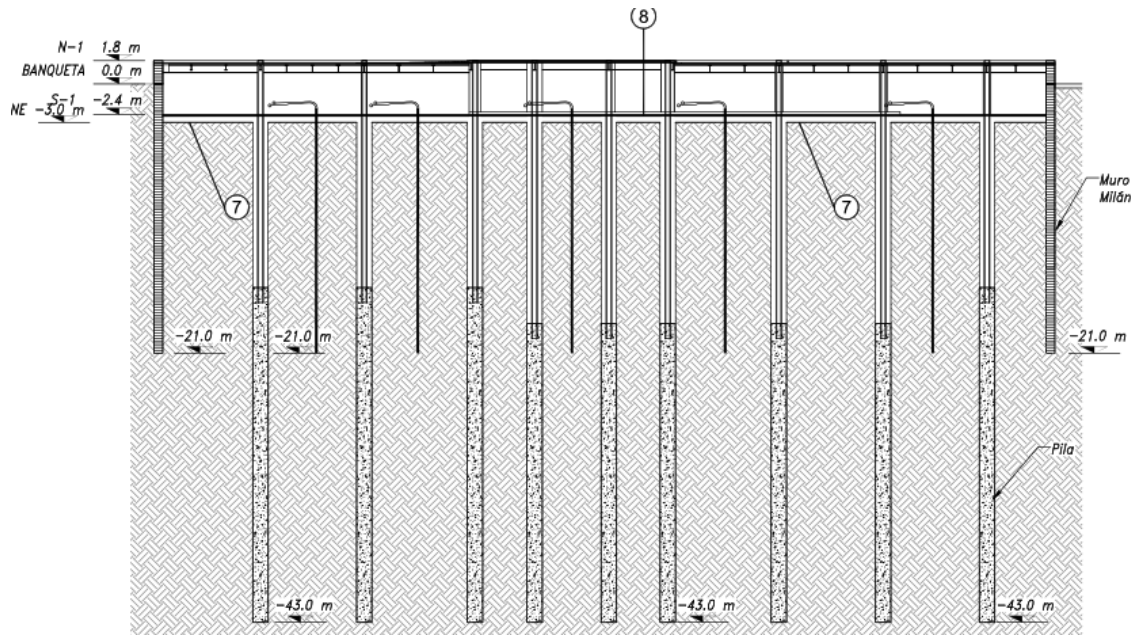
Proceso constructivo Top-Down – Etapas 7 y 8. Fuente: Cortesía del proyecto Marina 385
